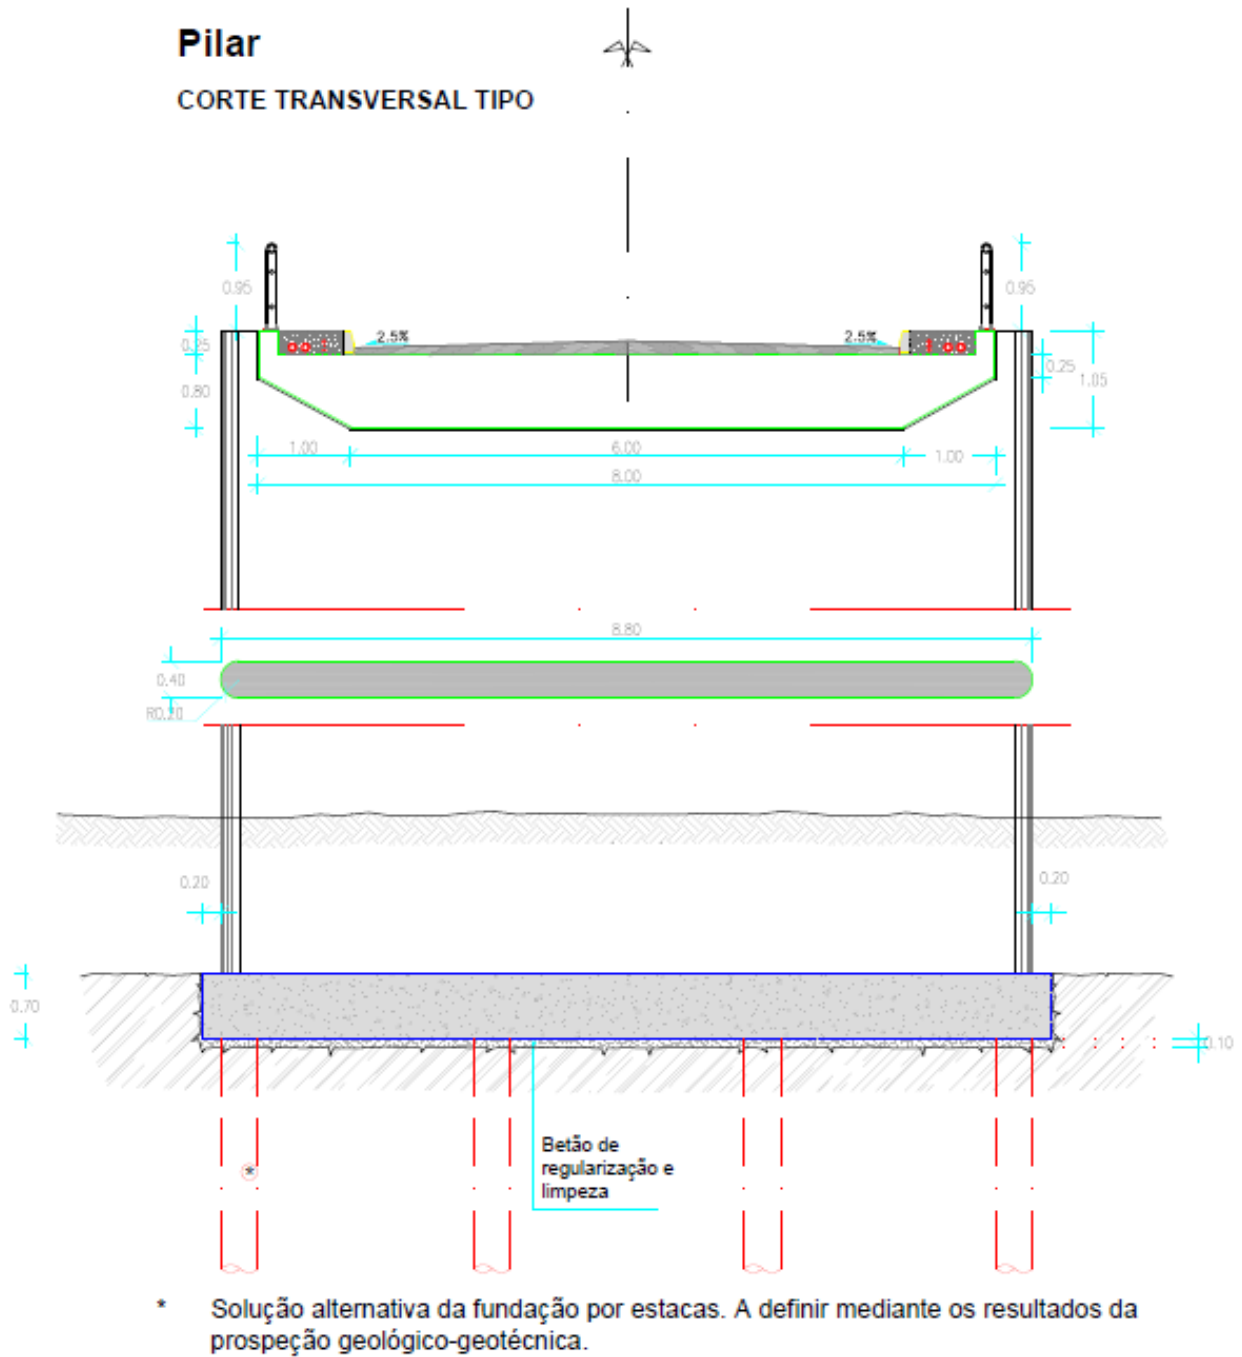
Secção transversal e alçado tipo de um pilar. 1ª localização aconselhada.
